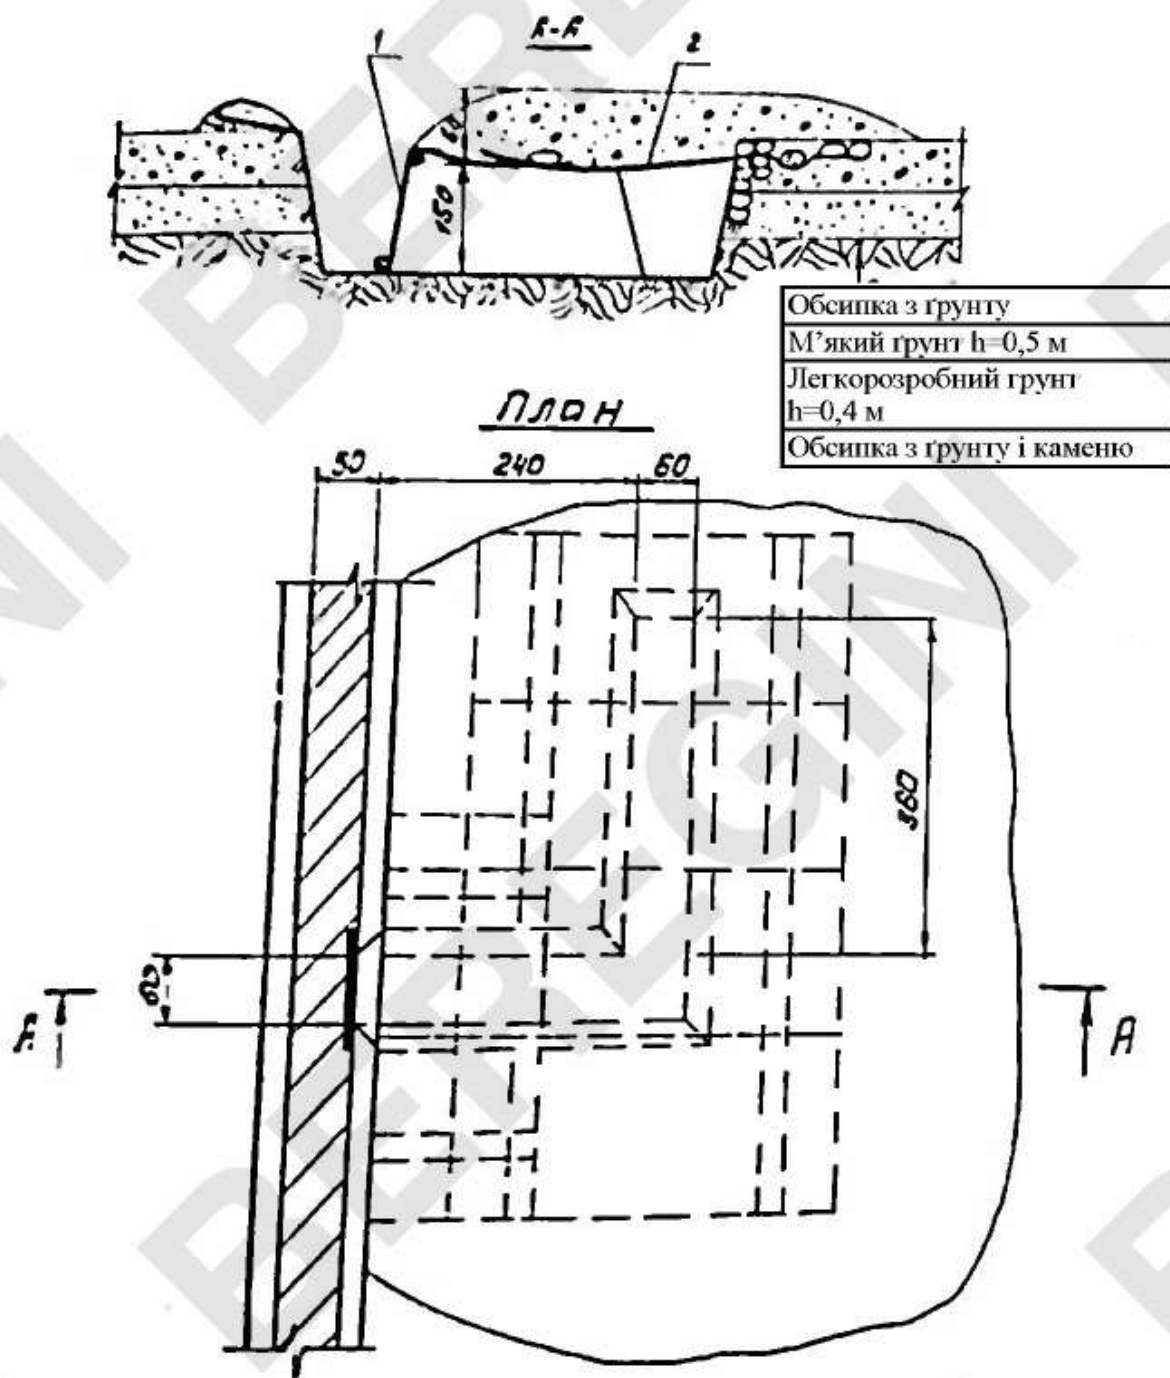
Щілина на відділення з перекриттям із армованої сітки:
